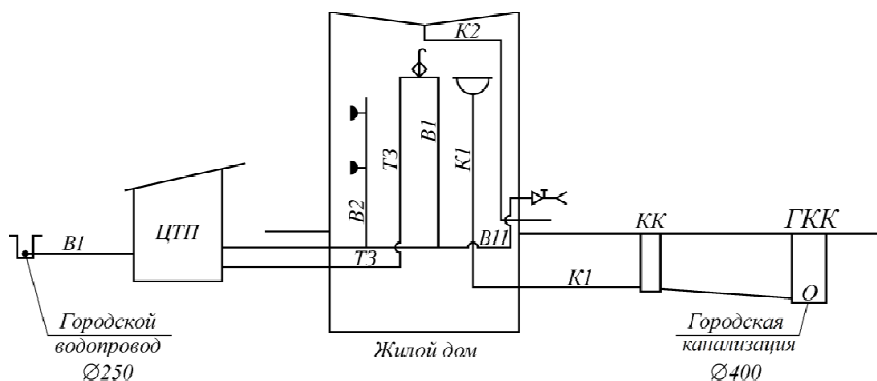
Схема водоснабжения и водоотведения жилого дома:
